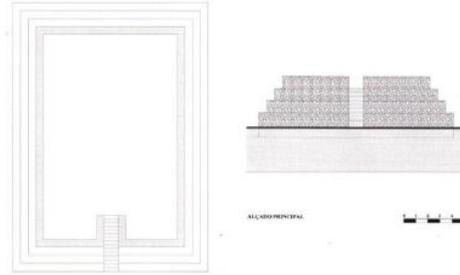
Mirante – Alçado lateral nascente e alçado principal
